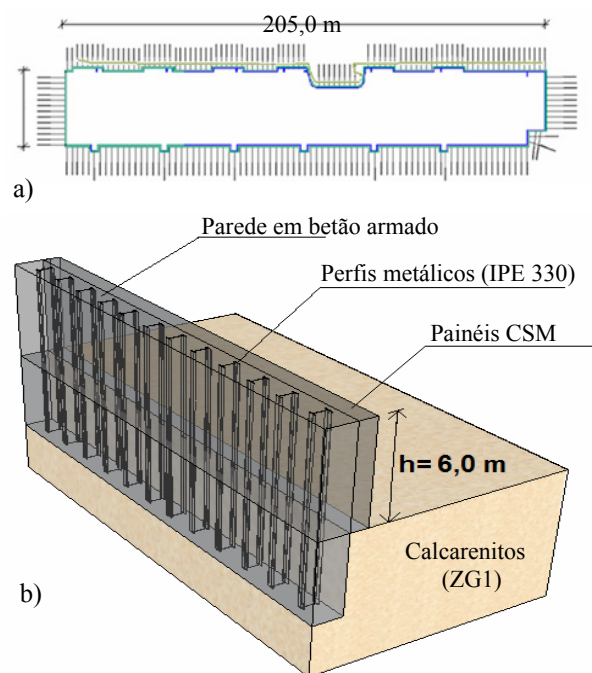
Caso de Estudo 1: a) planta da escavação; b) aspecto 3D da solução estrutural.
